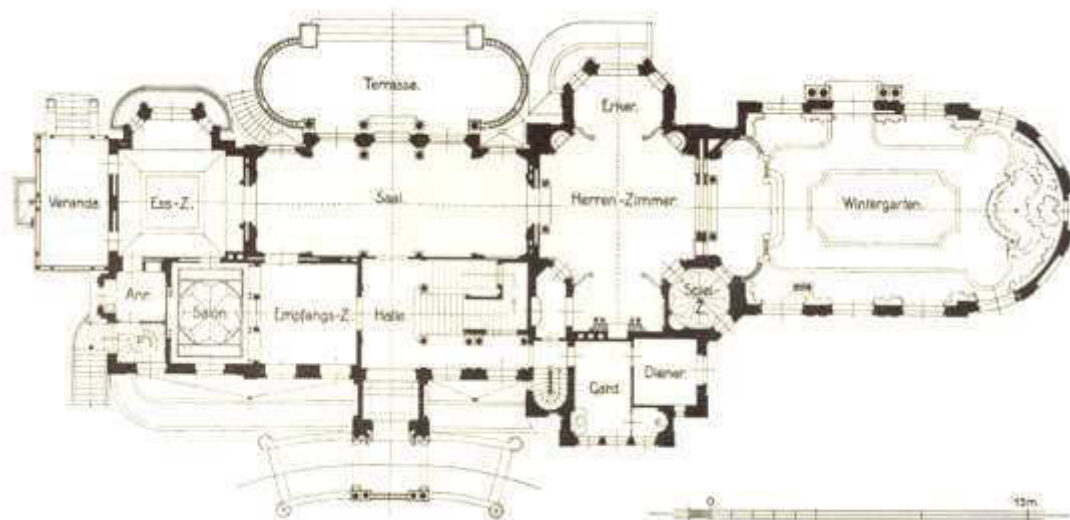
Villa Messtorff in Bergedorf, Grundriss Erdgeschoss.
